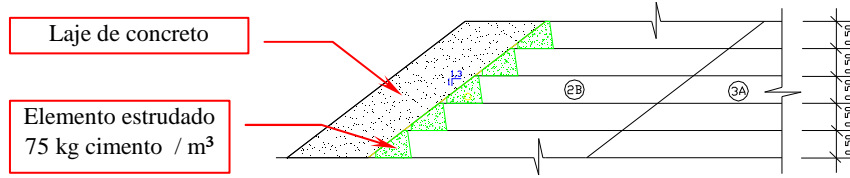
Sequência dos trabalhos de preparação do substrato para recebimento da laje.
